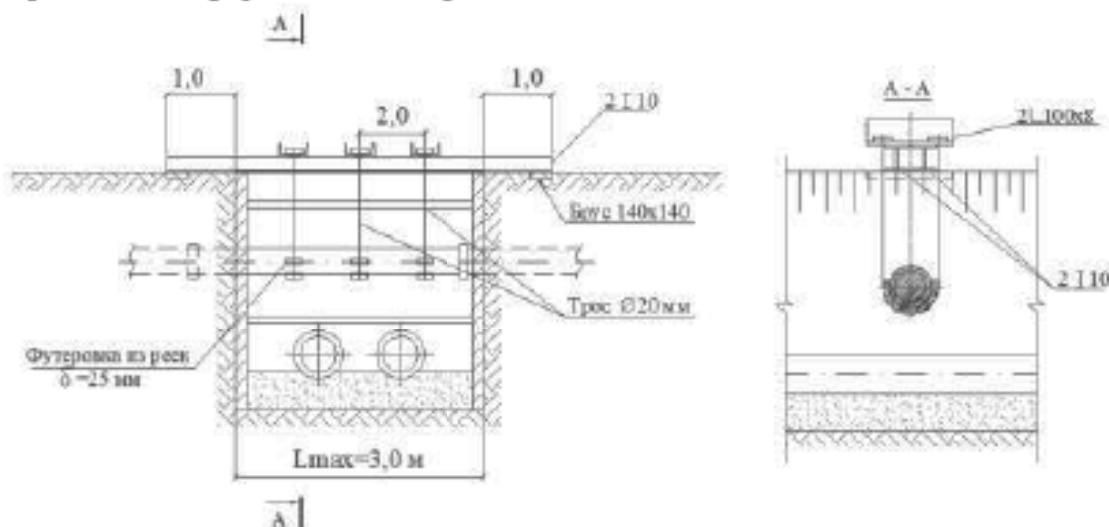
Водопровод или канализация из чугунных железобетонных труб
